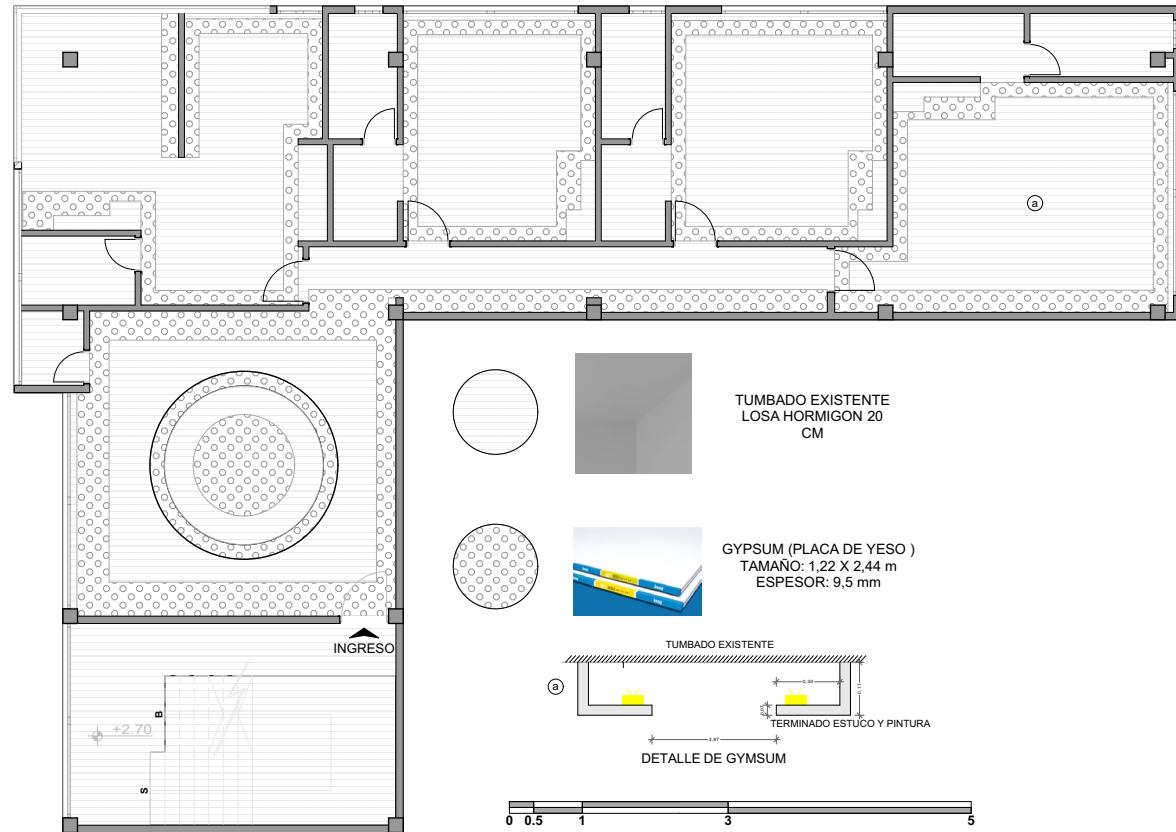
Autoría Jose Cruz. Plano de Techo.
